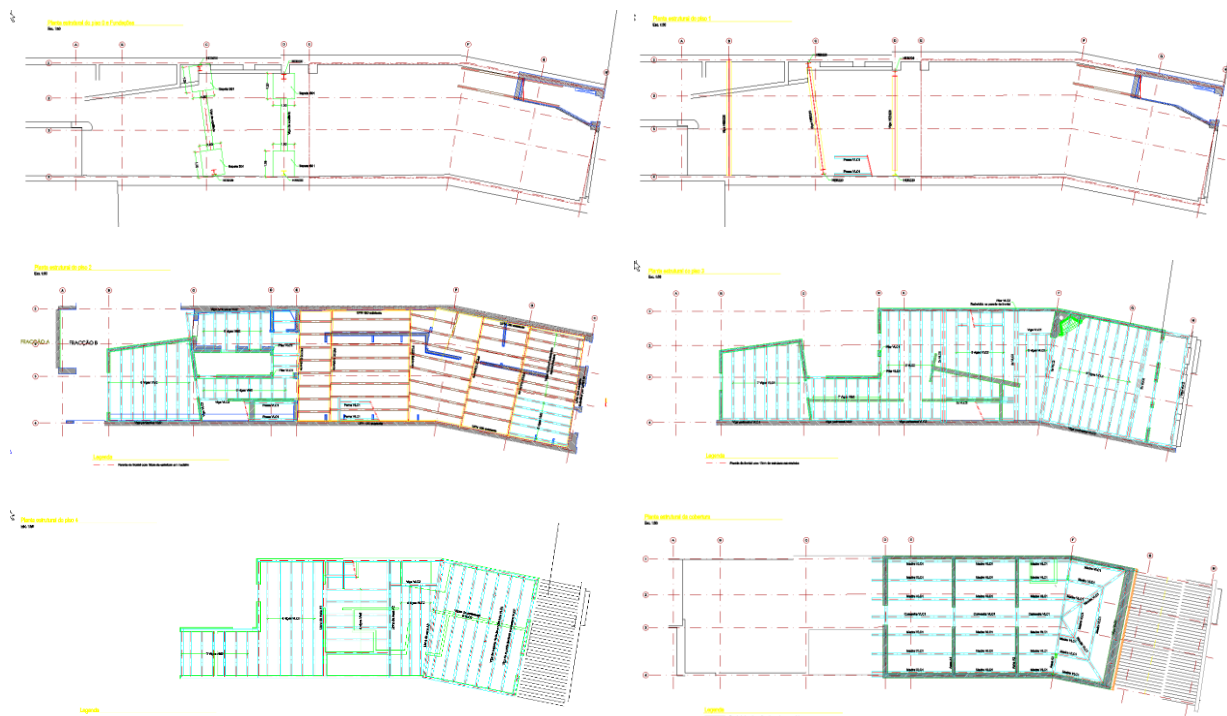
Plantas estruturais disponibilizadas pelo NCREP.
